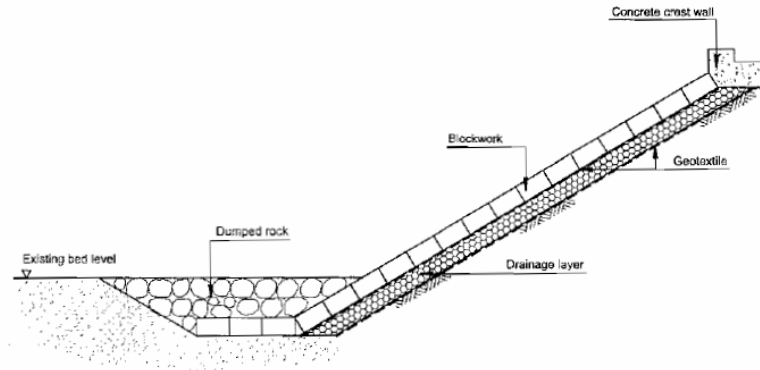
Esquema típico de obra en talud, protegido con bloques premoldeados de hormigón (McConnell, 1998)
